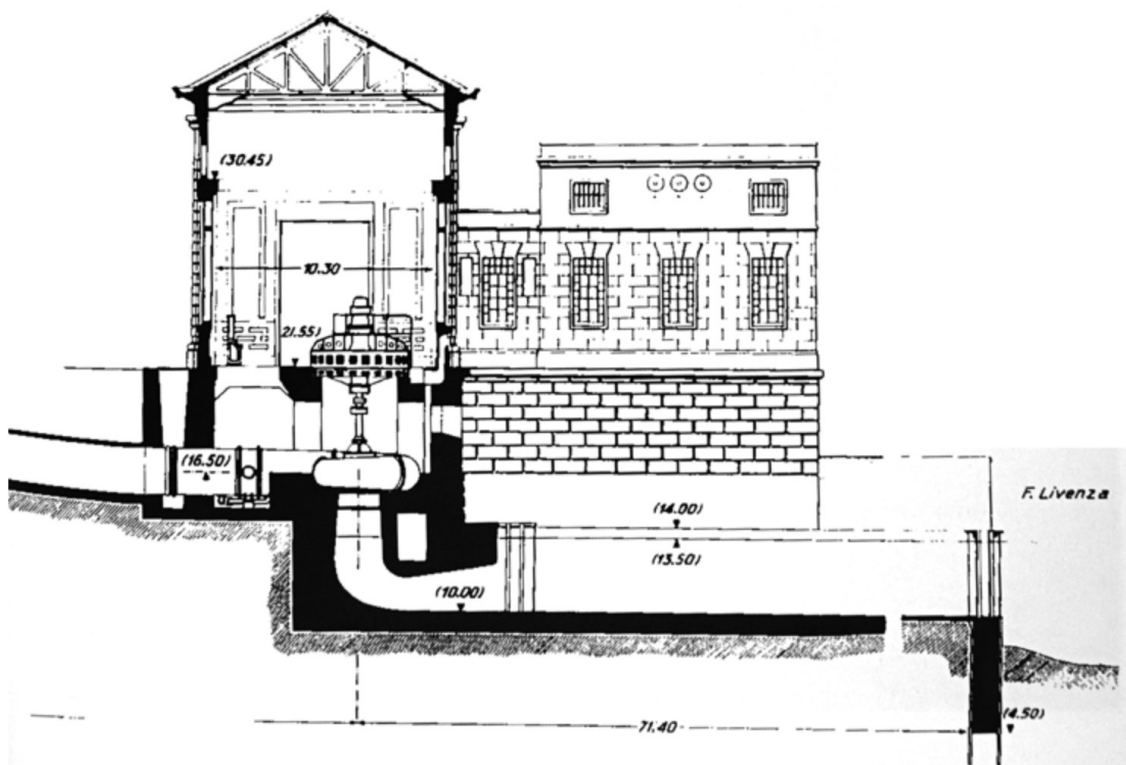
Sezione longitudinale della centrale del Livenza con le quote di adduzione e restituzione.
